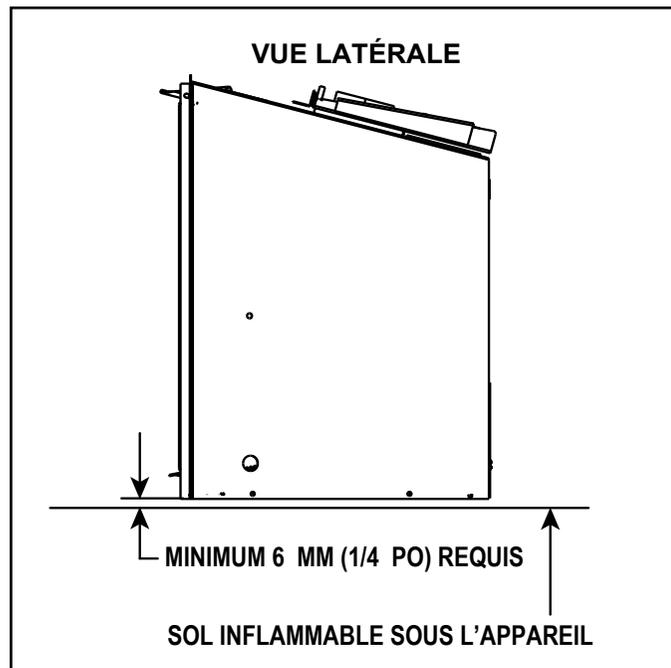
Dégagement par rapport au sol pour combustible solide
